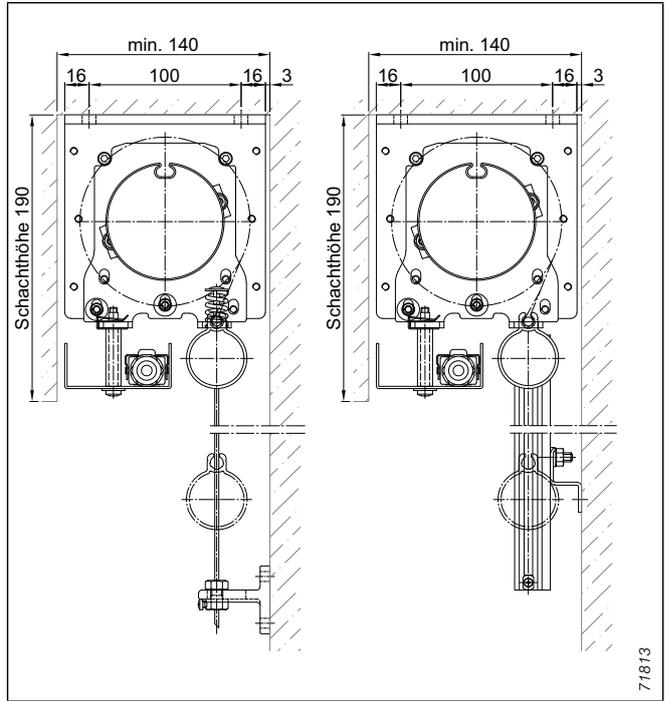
Senkrecht Markise Schacht: Größe M – Deckenmontage
